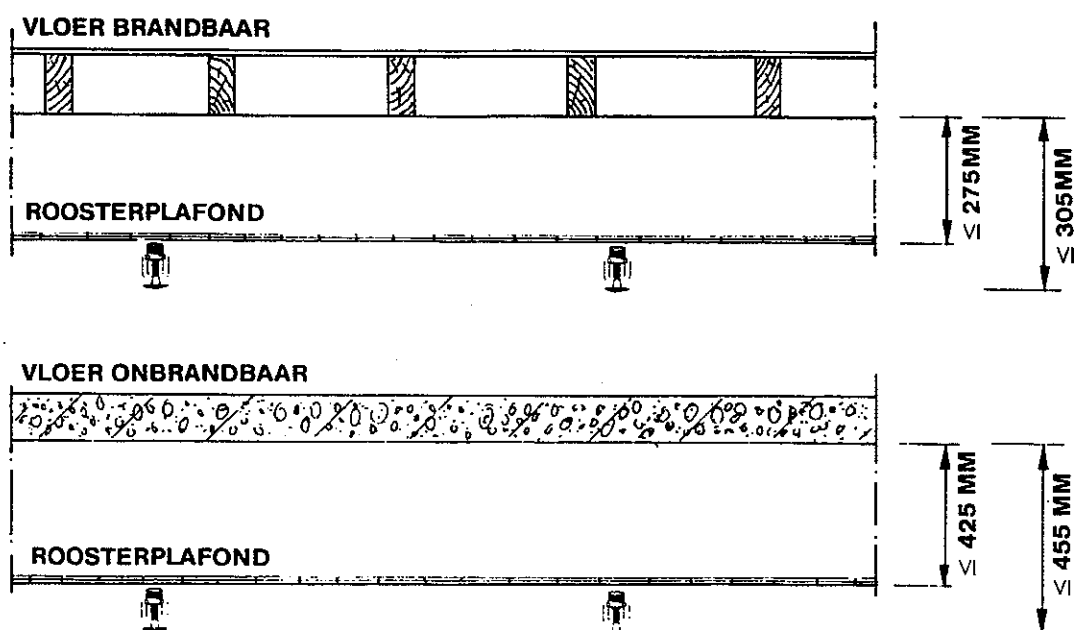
(B) Sprinklers onder en boven open-roosterplafond
